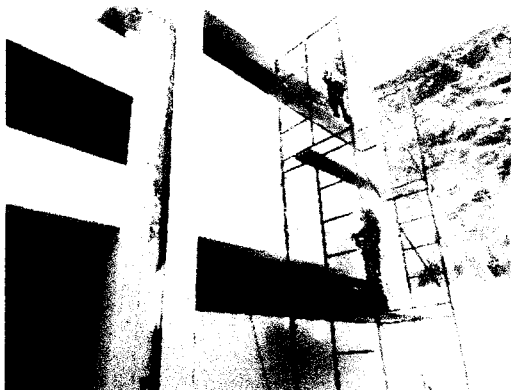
y 30: Pintado de muros, columnas, vigas y derrames con imprimante. TAREAS PREVIAS Y TANQUE ELEVADO
